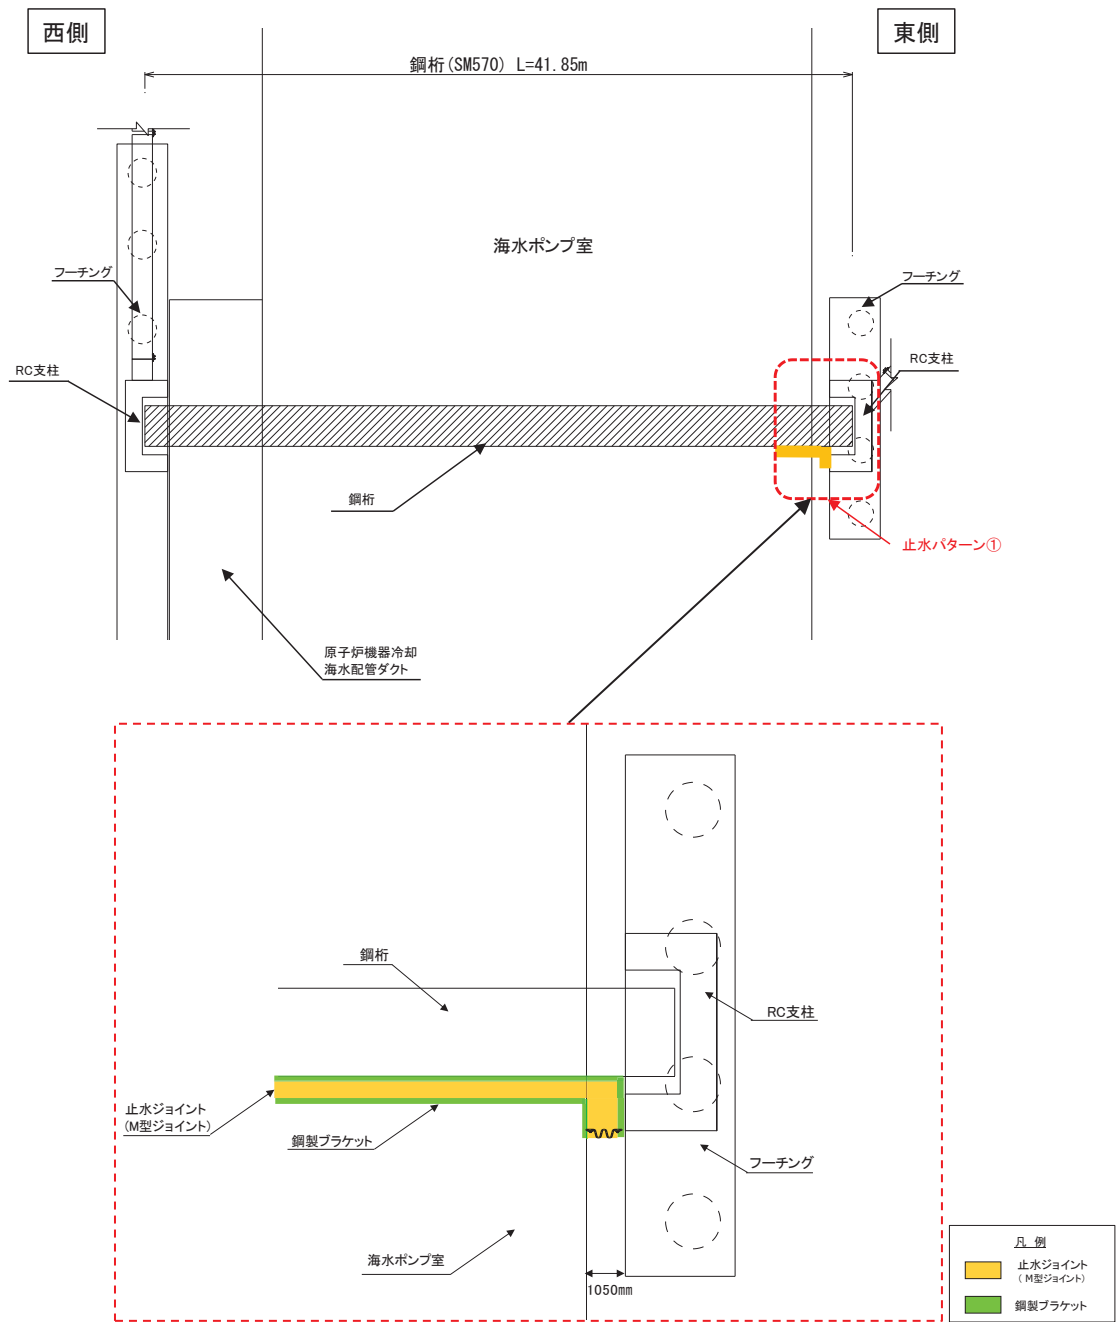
(2) 止水パターン①の構造概要(平面図)
